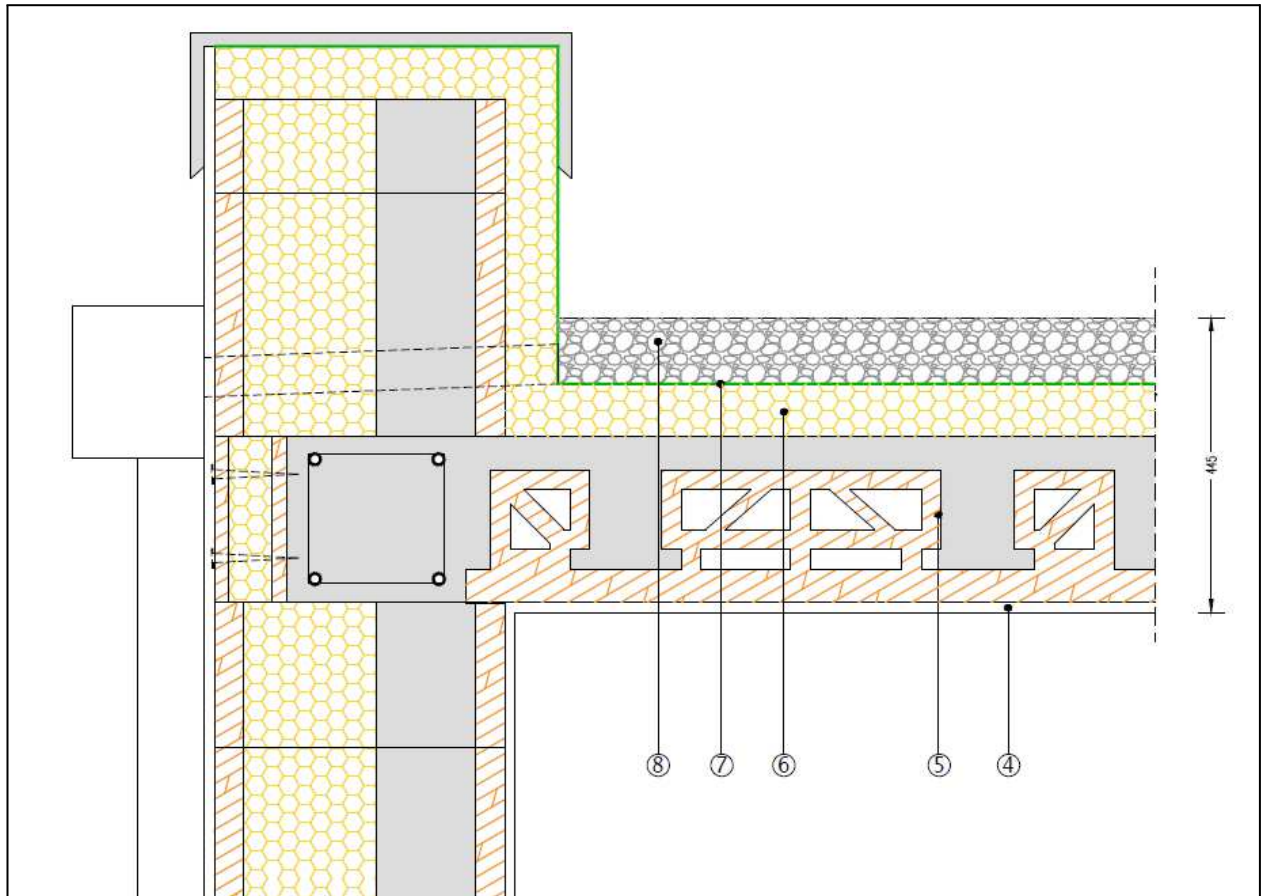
Sistema con blocco cassero in legno cemento nodo parete perimetrale-solaio copertura
